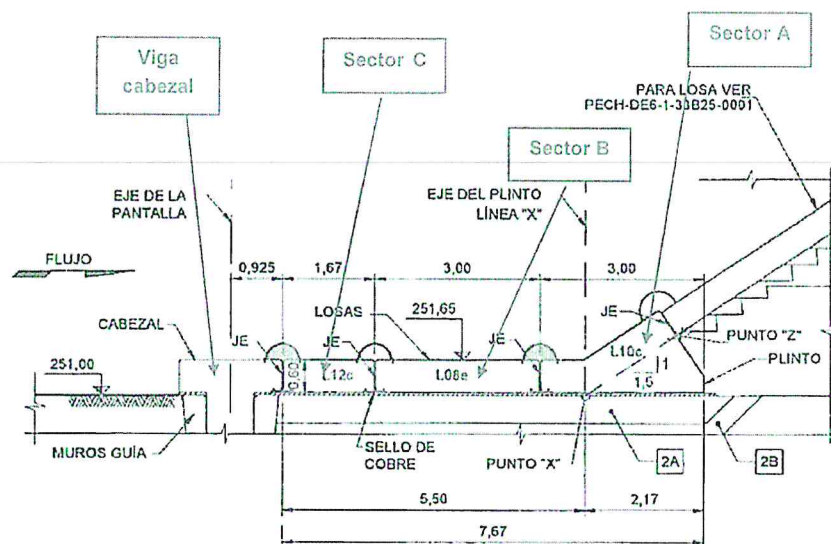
Plinto flexible o articulado de la presa (cimentación cauce)
